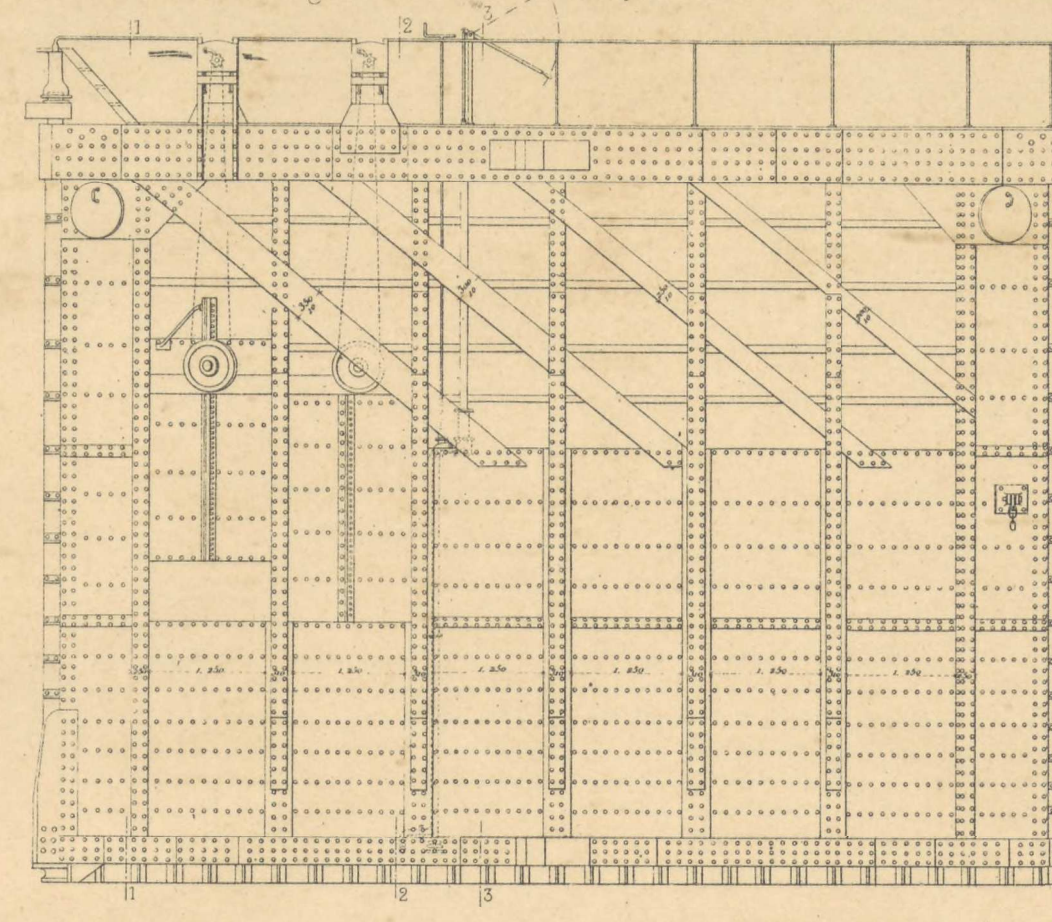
Plan de la porte d'ébe et de la porte valet, la passerelle enlevée.
